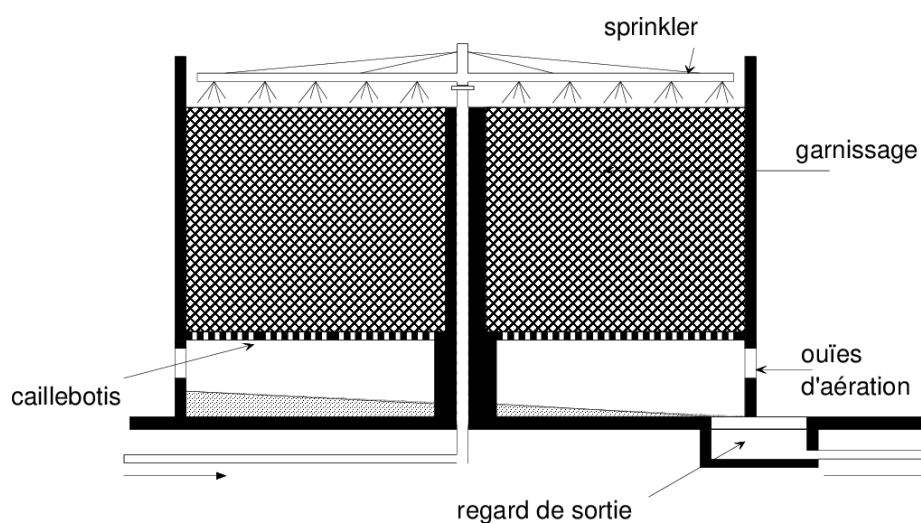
Schéma d'un lit bactérien en coupe verticale [22]
